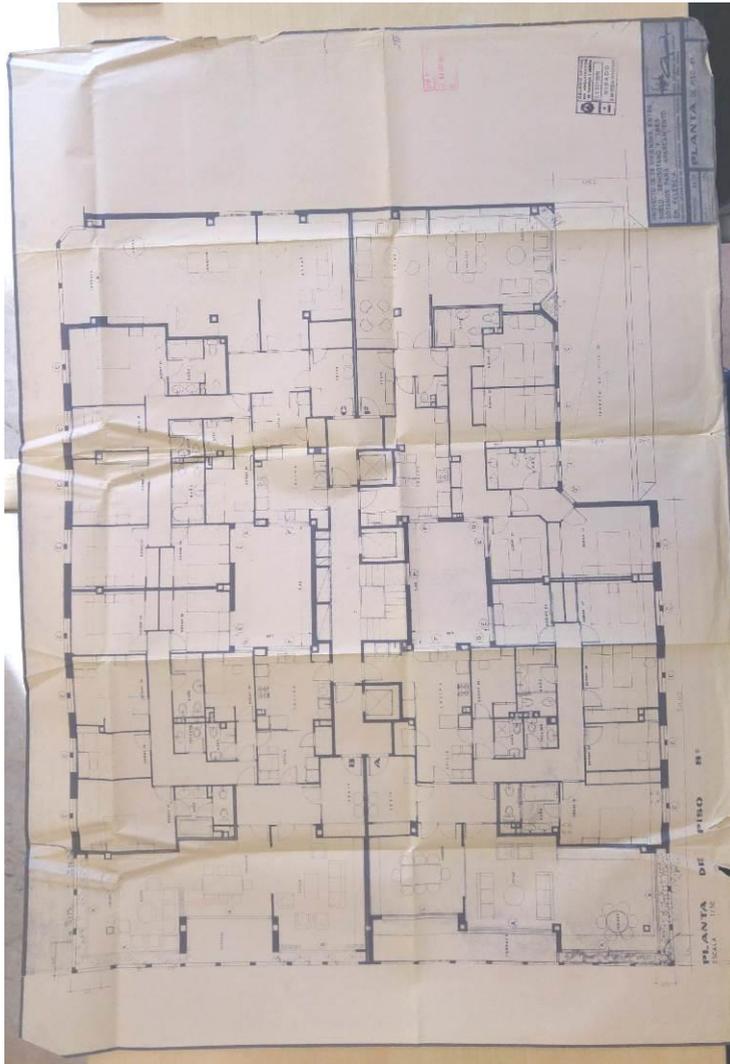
Planta 8º y ubicación vivienda matriz. 2018
